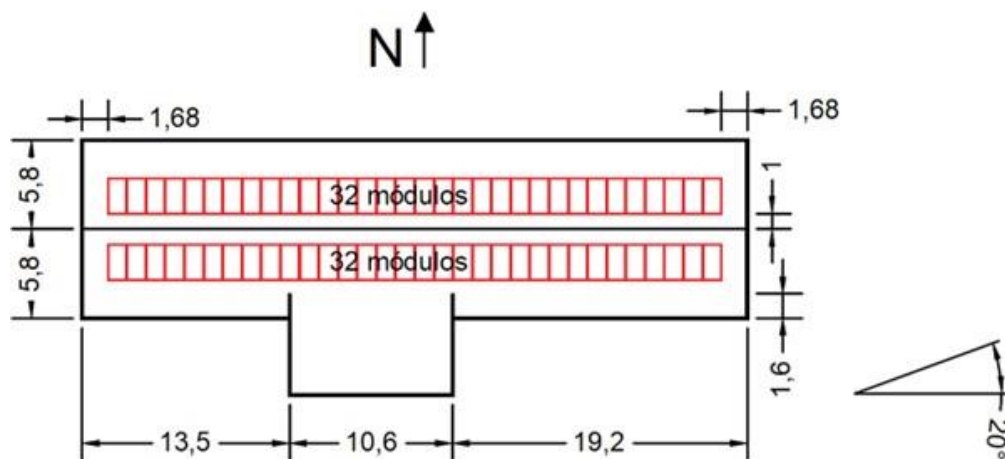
(IFSC – LabDida) Vista de cima do lugar da instalação com distâncias e layout dos módulos.
